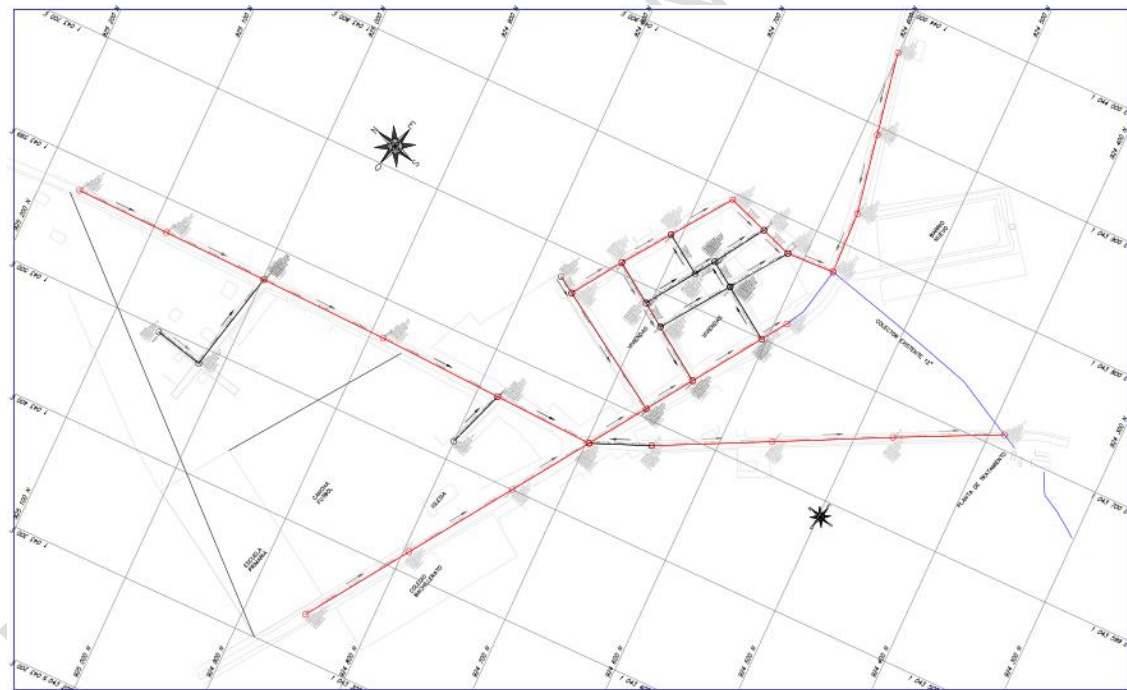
Cobertura de Alcantarillado en el Centro Poblado Chichimene
